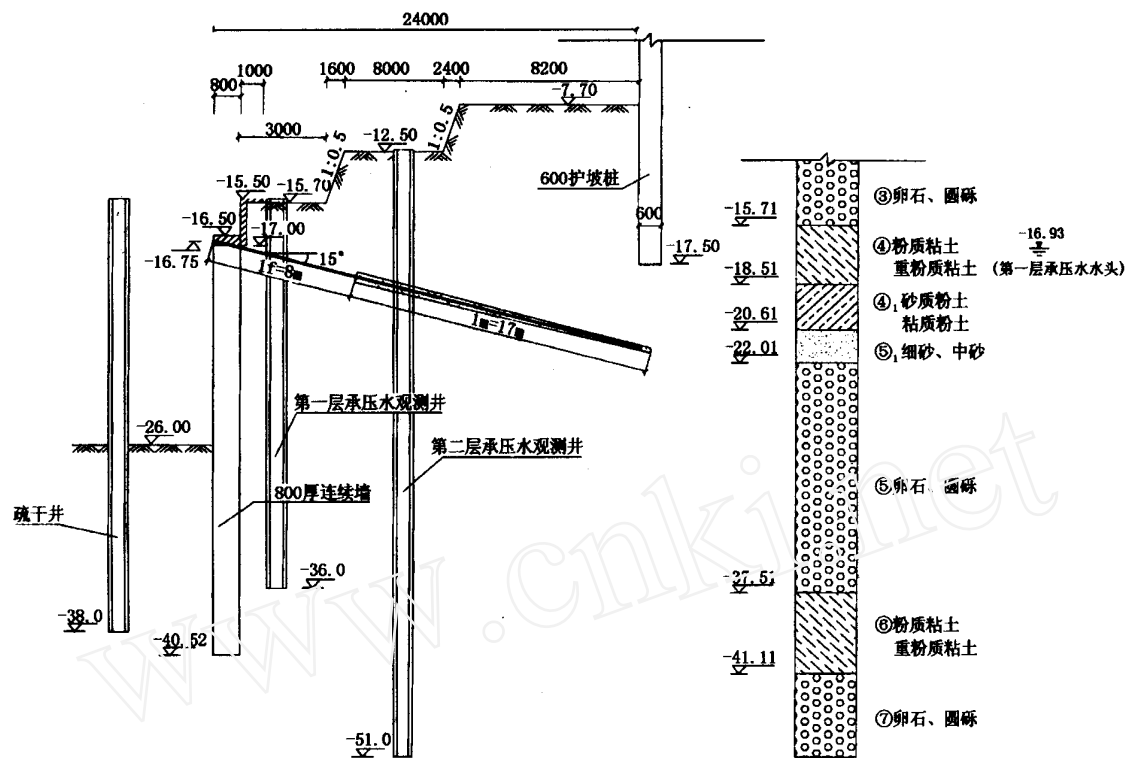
大面积 - 26 m 基坑地下连续墙锚杆支护和地下水控制设计剖面图
